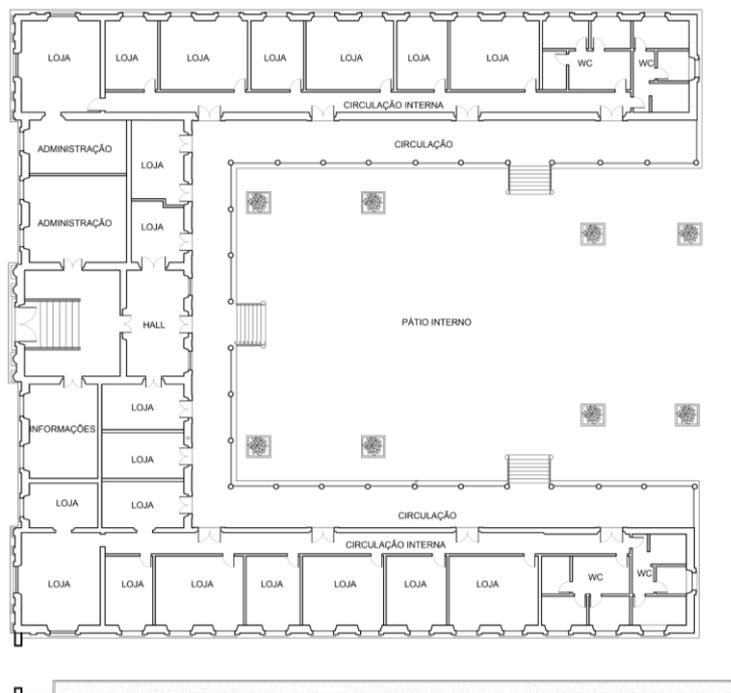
Diferença da planta da CEHOP marcada sob a planta da EMSETUR.
